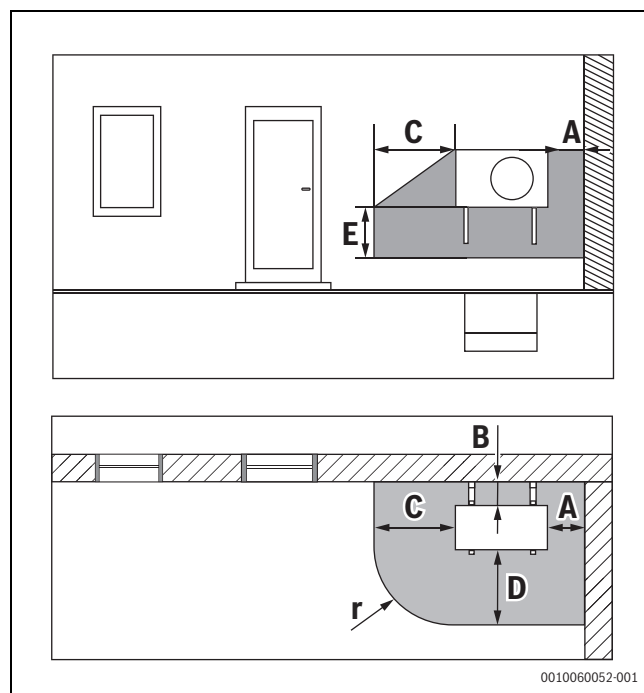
Schutzbereich, wandmontierte Wärmepumpe
